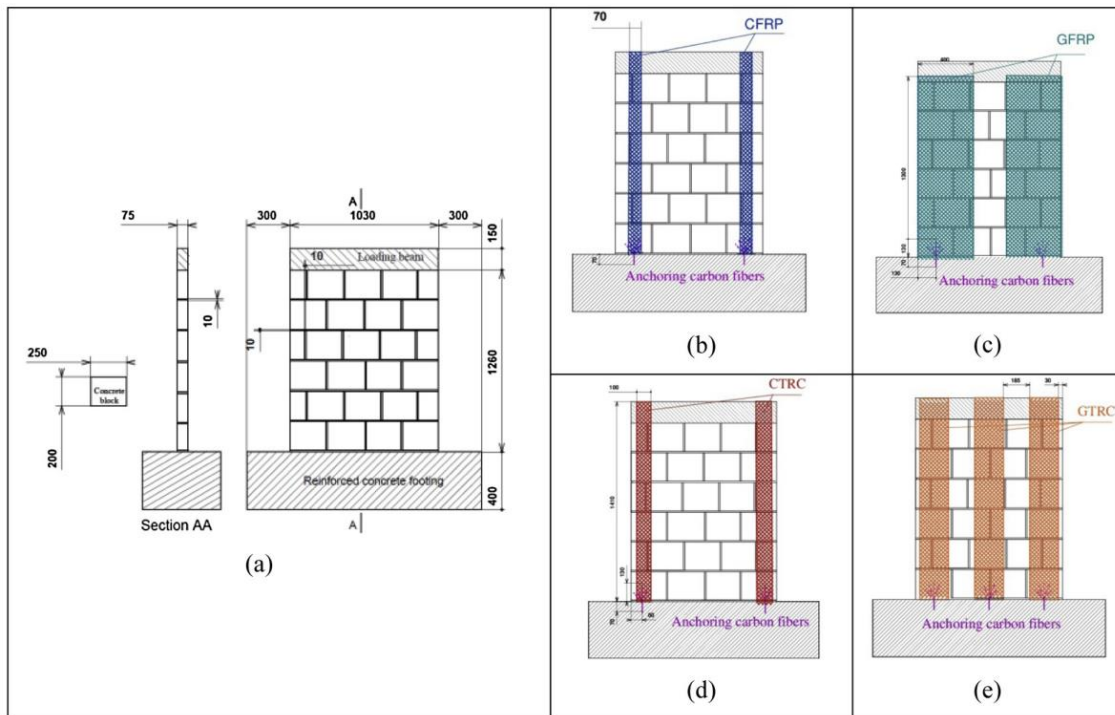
Parede de alvenaria sem reforço e esquemas de reforço (Reboul *et al.*, 2018).
